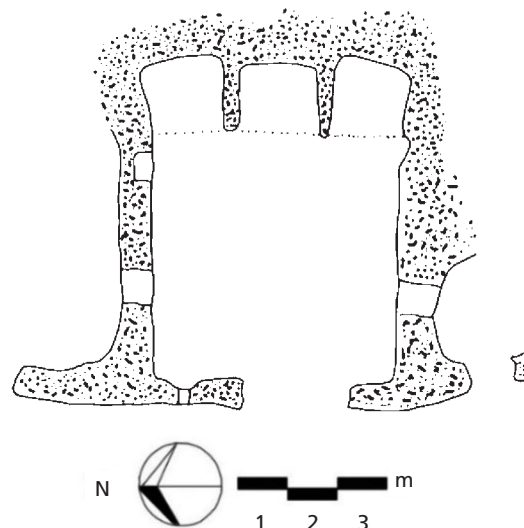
Deir Hadetke, Felsenkirche, Grundriss. – (Nach Wießner, Christliche Kultbauten 3, Fig. 19).
